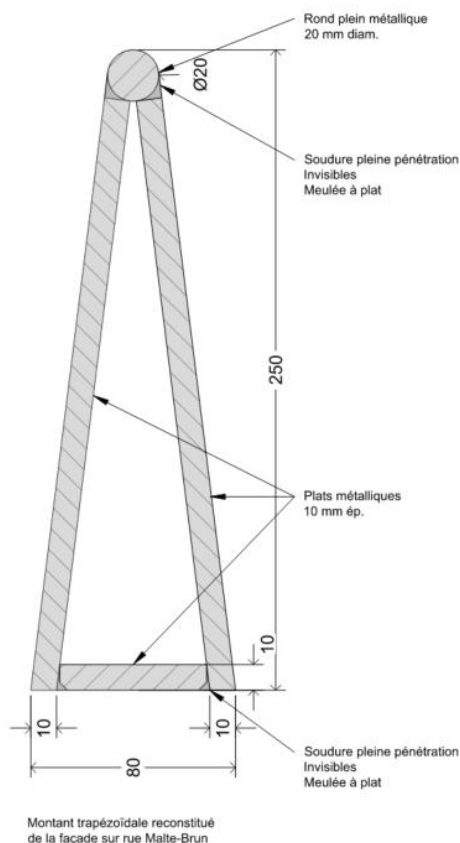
Montant trapézoïdal reconstitué de la façade d'entrée
